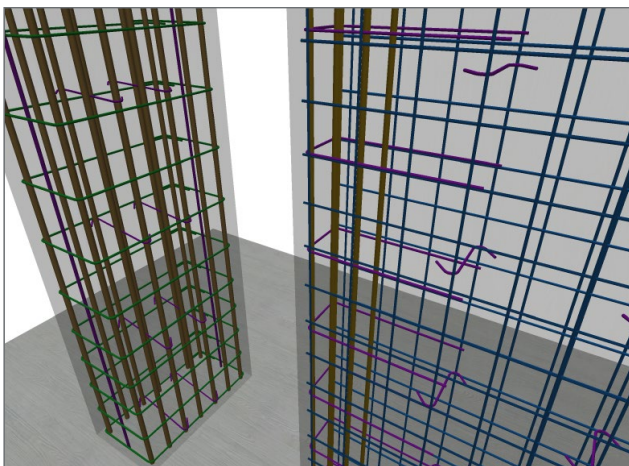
Bewehrungsübergabe in ViCADO (S402.de, S442.de)
